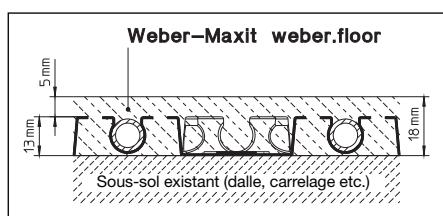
Weber-Maxit weber.floor (recouvrement minimal 5 mm, hauteur total de mise en œuvre 18 mm)
